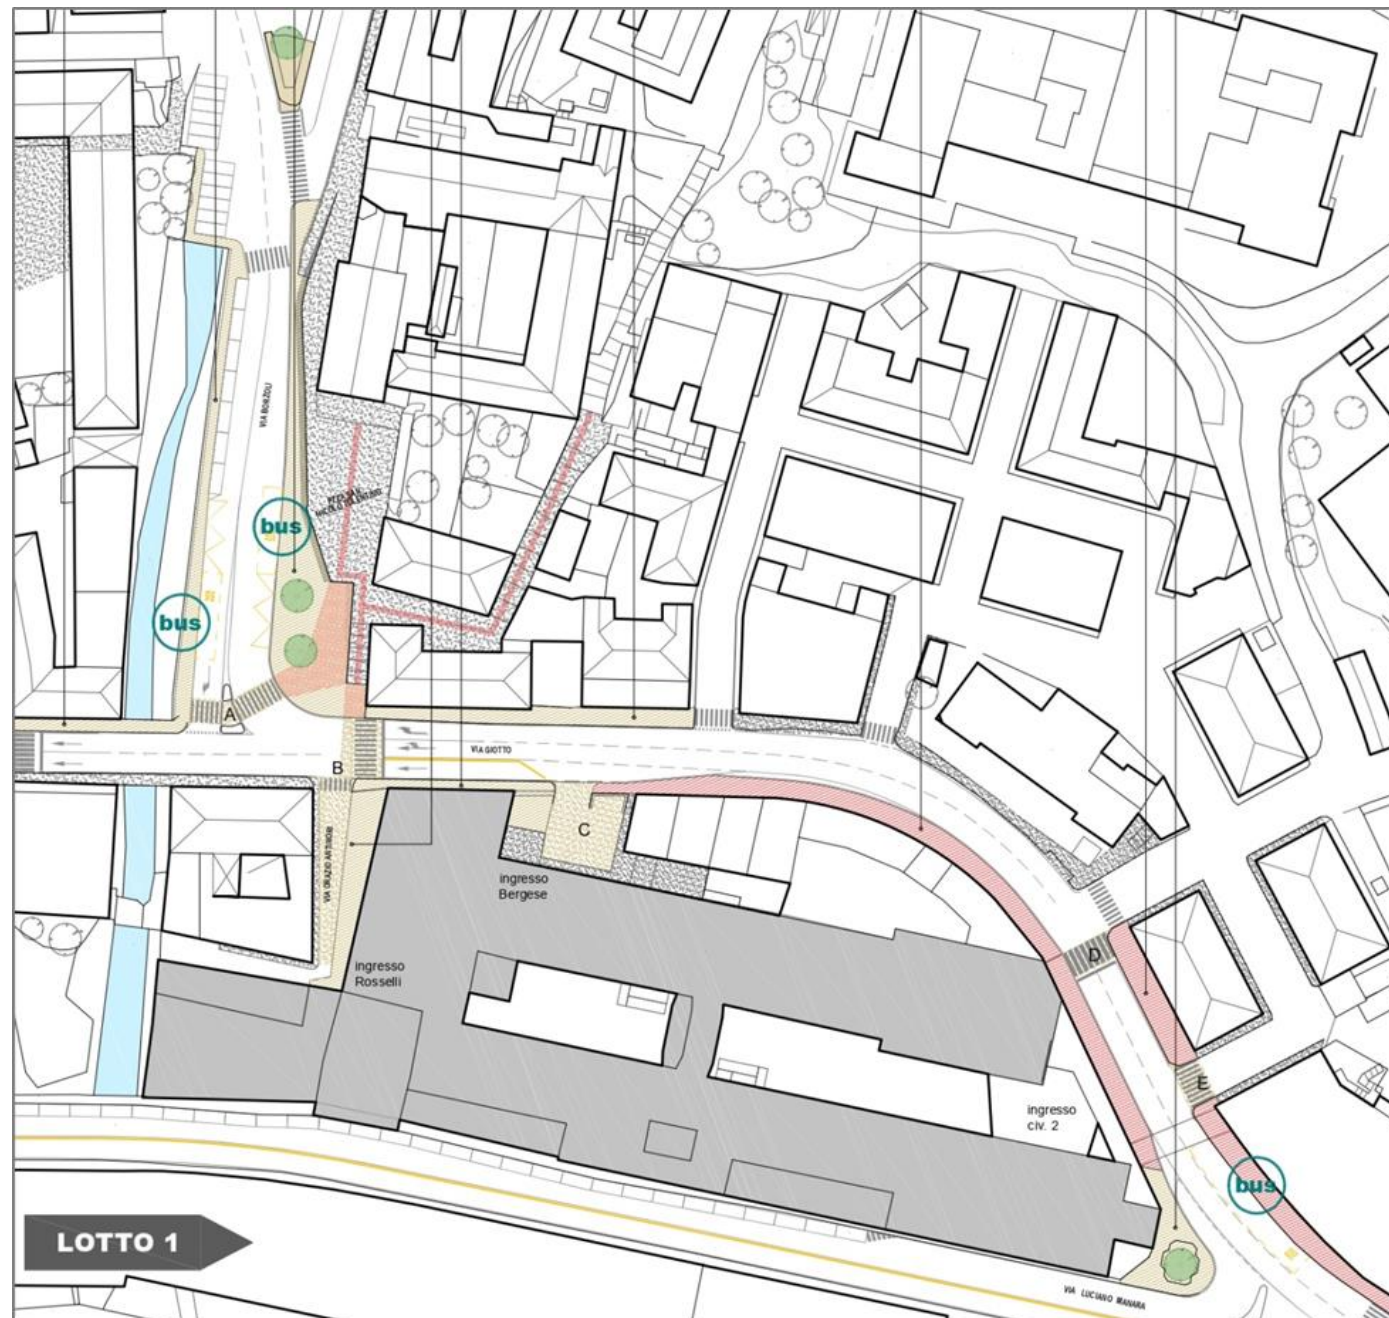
Planimetria dell'intervento di riorganizzazione della accessibilità al polo scolastico di Via Giotto
